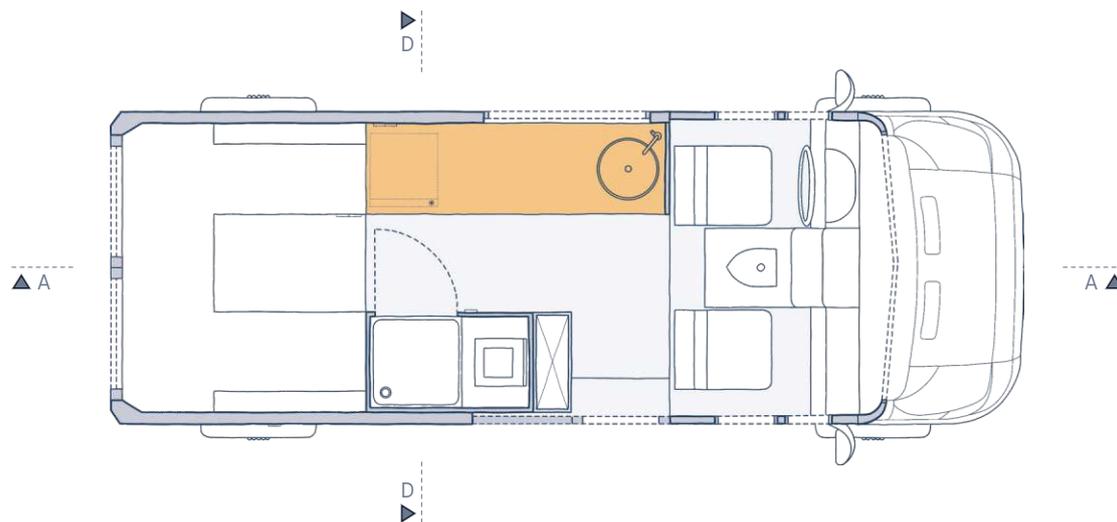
Campervan für zwei Personen - Küche - Grundriss (Maßstab 1:50)
